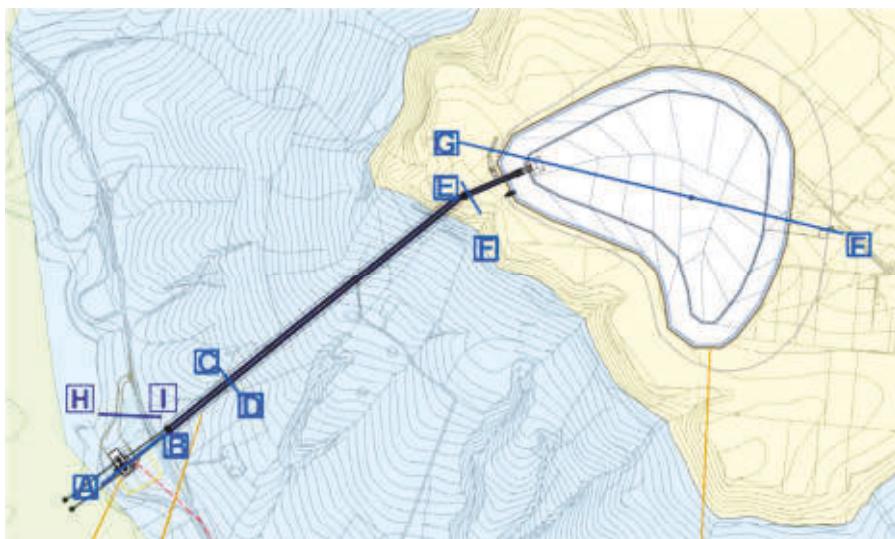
Estratto della planimetria di progetto di cui all'Elaborato PD-EP.8.1.
